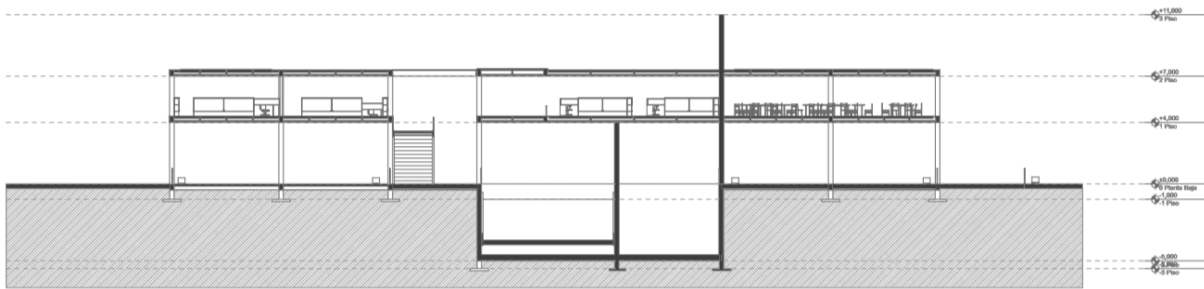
Corte A-A arquitectónico (Sanchez J. D., 2018)
